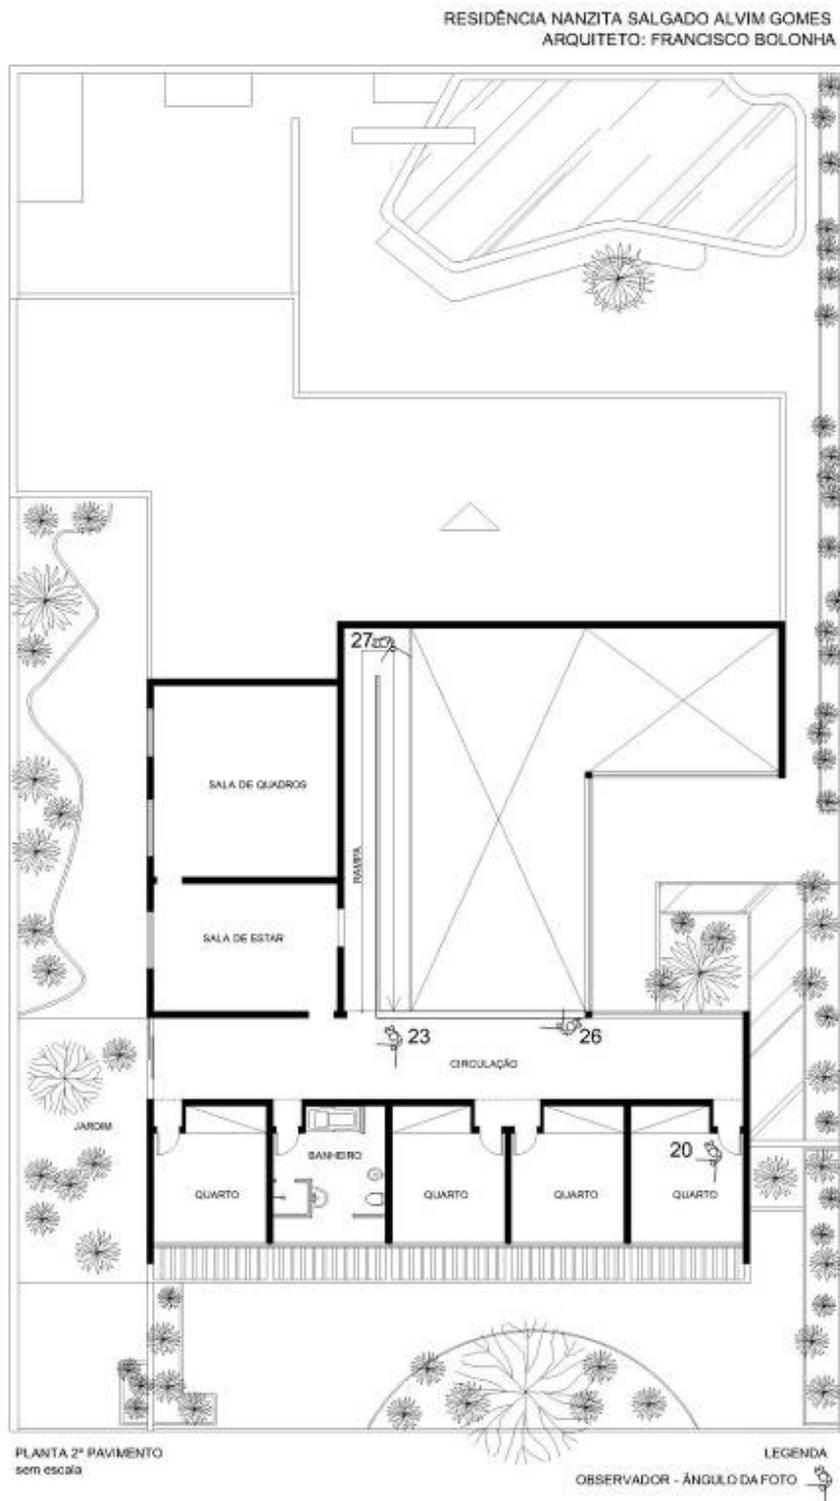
PLANTA 2º pavimento da Residência de Nanzita, arquiteto Francisco Bolonha. TELLES, Cairu (2007)
